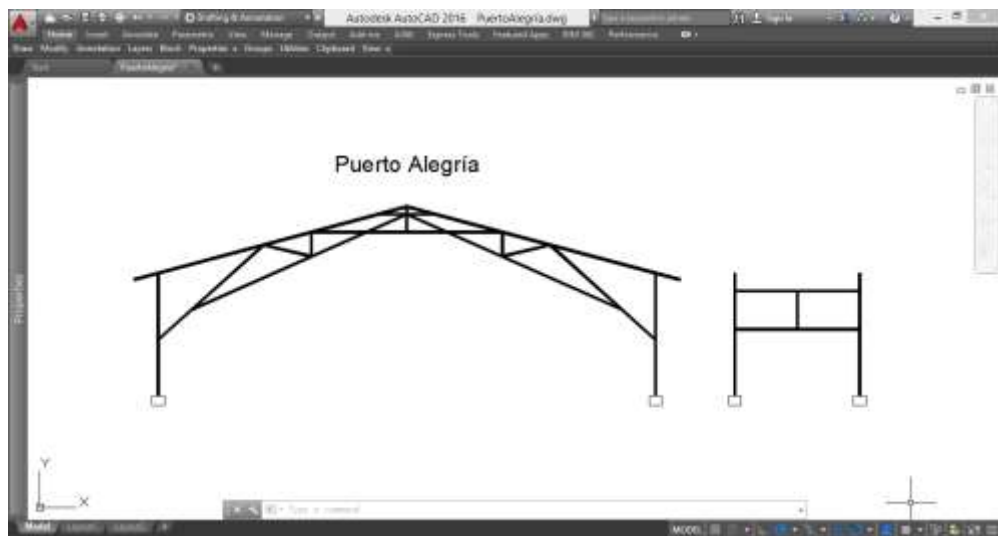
Plano generado en AutoCAD de la geometría inicial de la cubierta, Puerto Alegria
